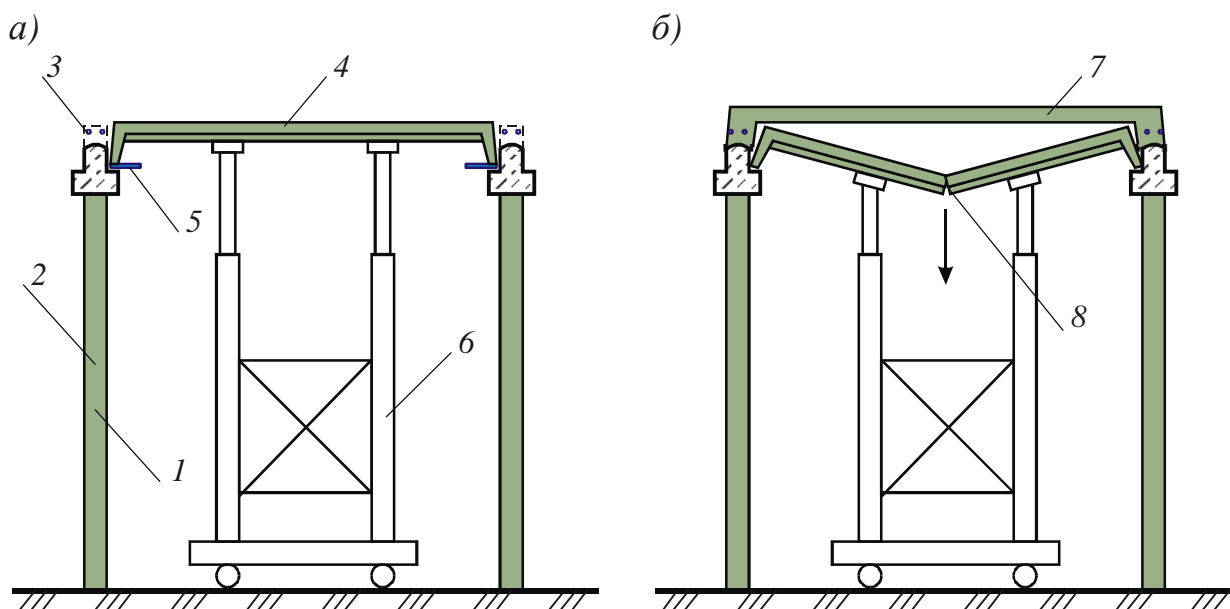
Замена сборных железобетонных плит перекрытия:
